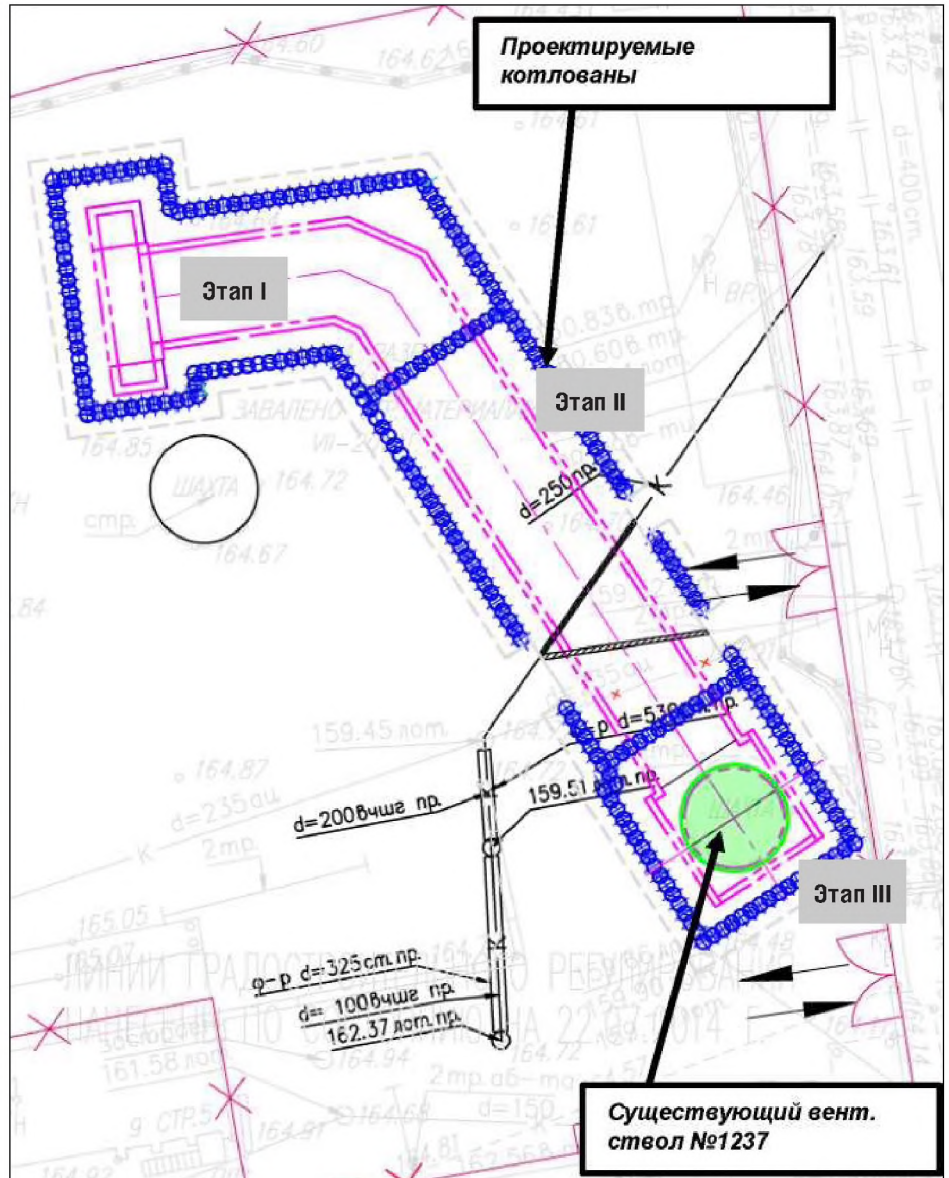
Этапы разработки котлована и бетонирования конструкций канала ВВУ
